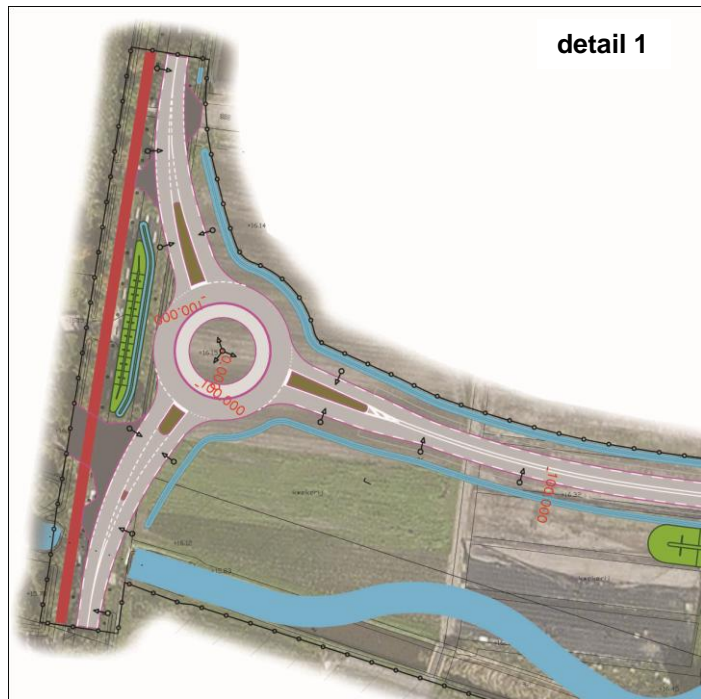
Planlocatie westelijk deel (aansluiting Boekelseweg; detail 1)
